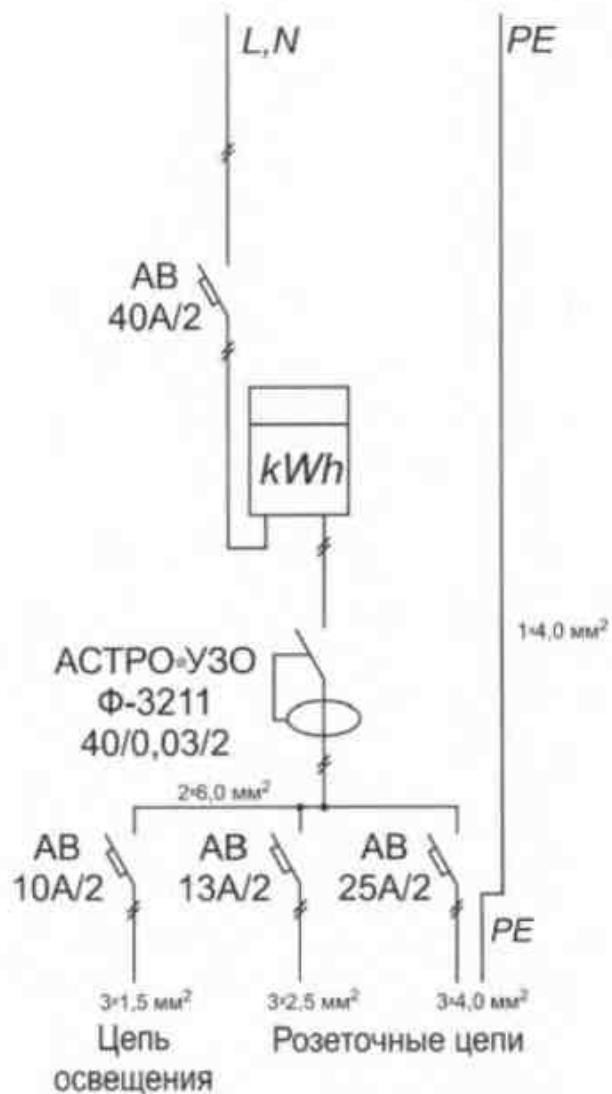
Схема электроснабжения квартиры с газовой плитой с рекомендуемыми сечениями медных проводников
